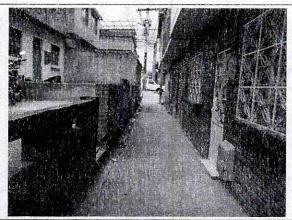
Segundo y tercer nivel de la edificación emplazada en la Diagonal 38 G Sur No. 11 A -
